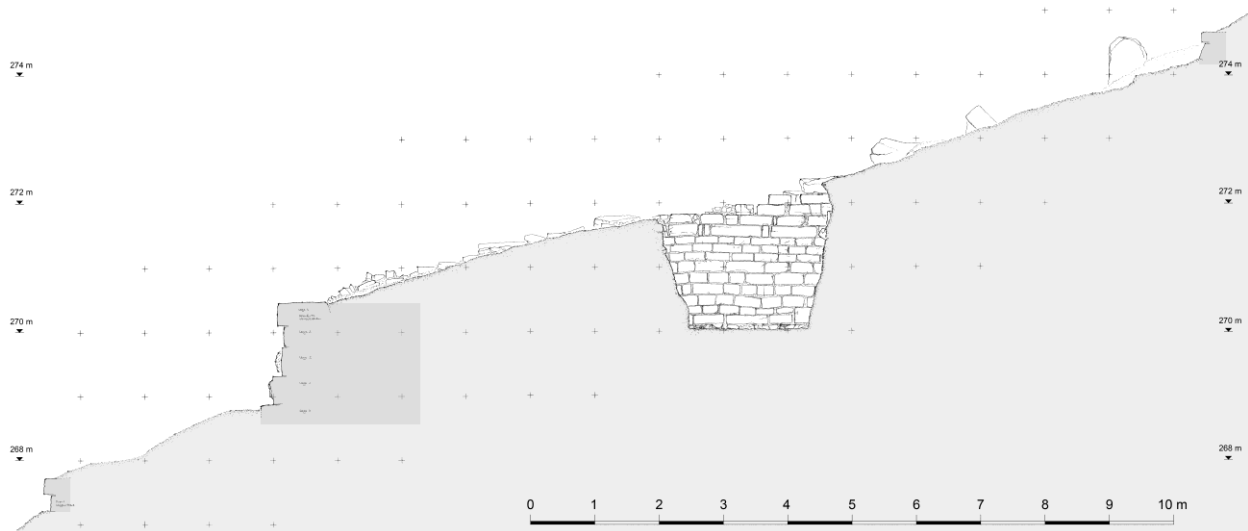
Sezione longitudinale con il prospetto nord del muro settentrionale all'interno del saggio n°2.
